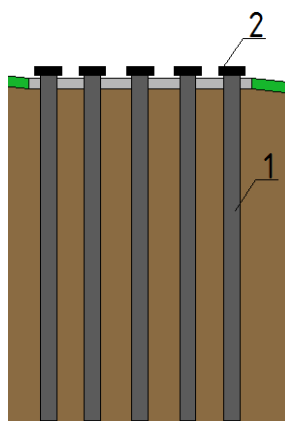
Устройство свай. 1 – трубобетонные сваи,
